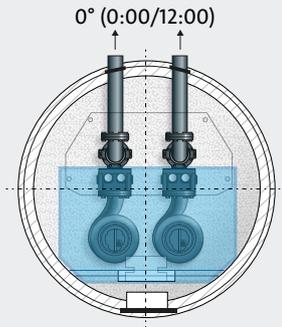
Ablaufrichtung einer Installation mit zwei Pumpen und VC-Rohren zur Ventilkammer
